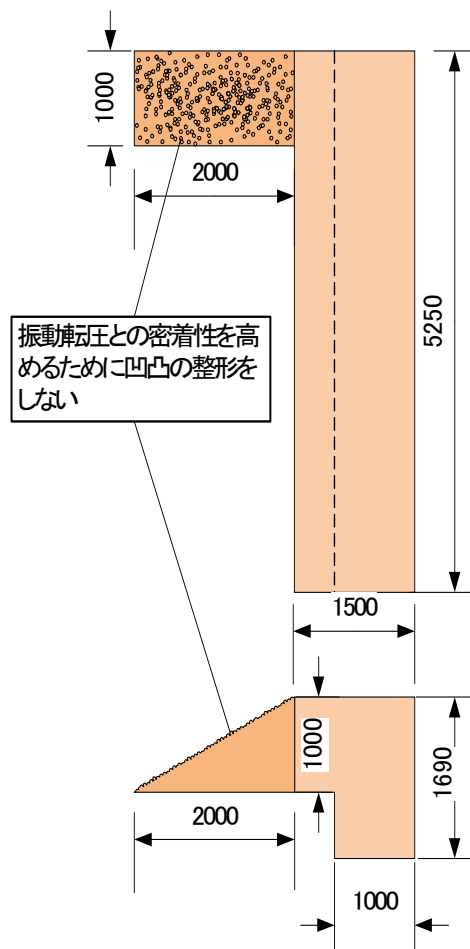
施工形状図 (上：平面図、下：断面図)
